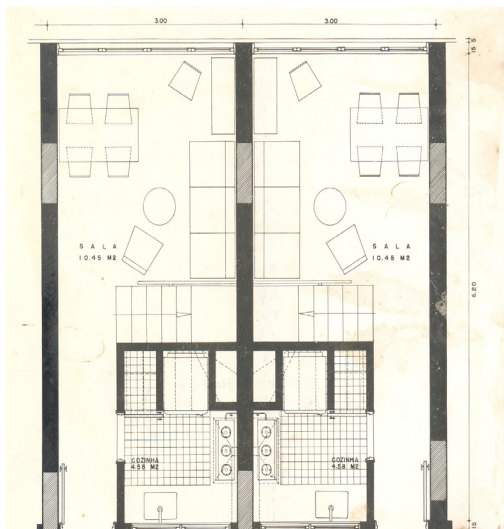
Planta do 1º pavimento do apartamento duplex.
